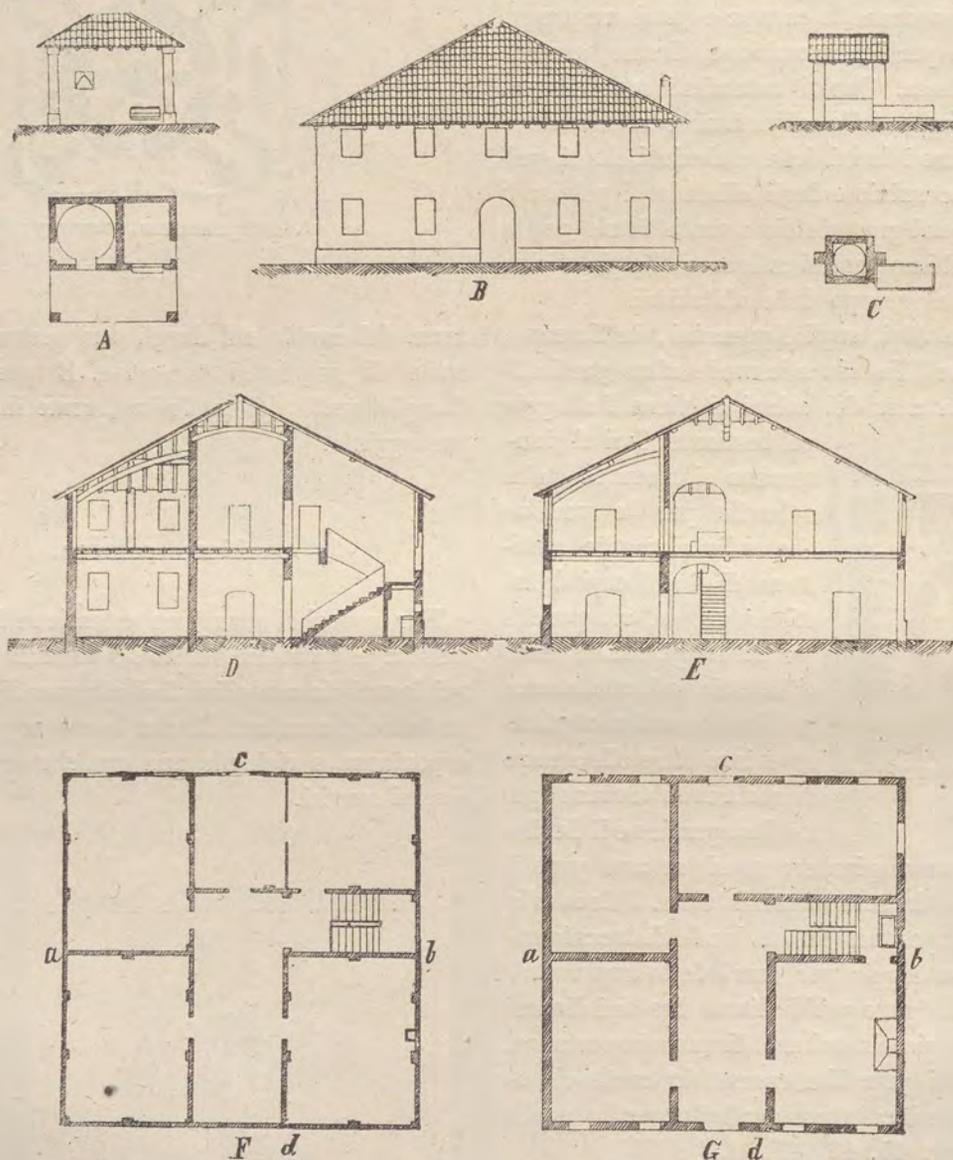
A. forno (alzato e pianta) — B. prospetto della casa colonica — C. pozzo (alzato e pianta) — D. sezione della casa colonica sulla linea a-b — E. sezione della casa colonica sulla linea c-d — F. pianta del piano superiore — G. pianta del piano terreno.
